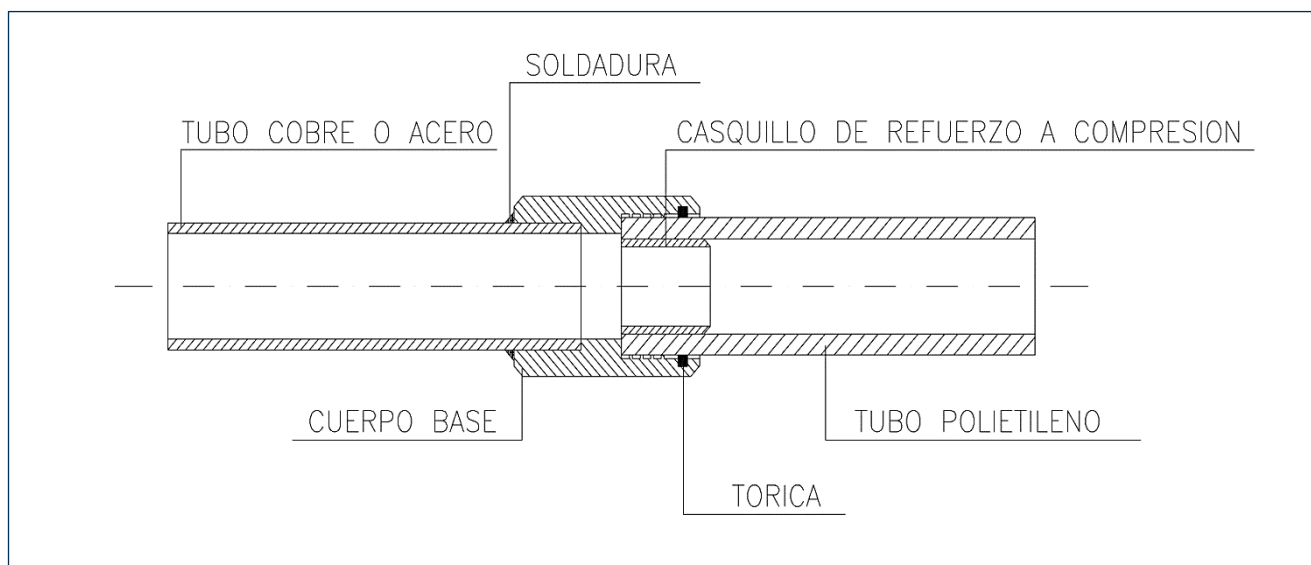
Esquema de enlace mecánico PE/PA-U por anclaje fijo
